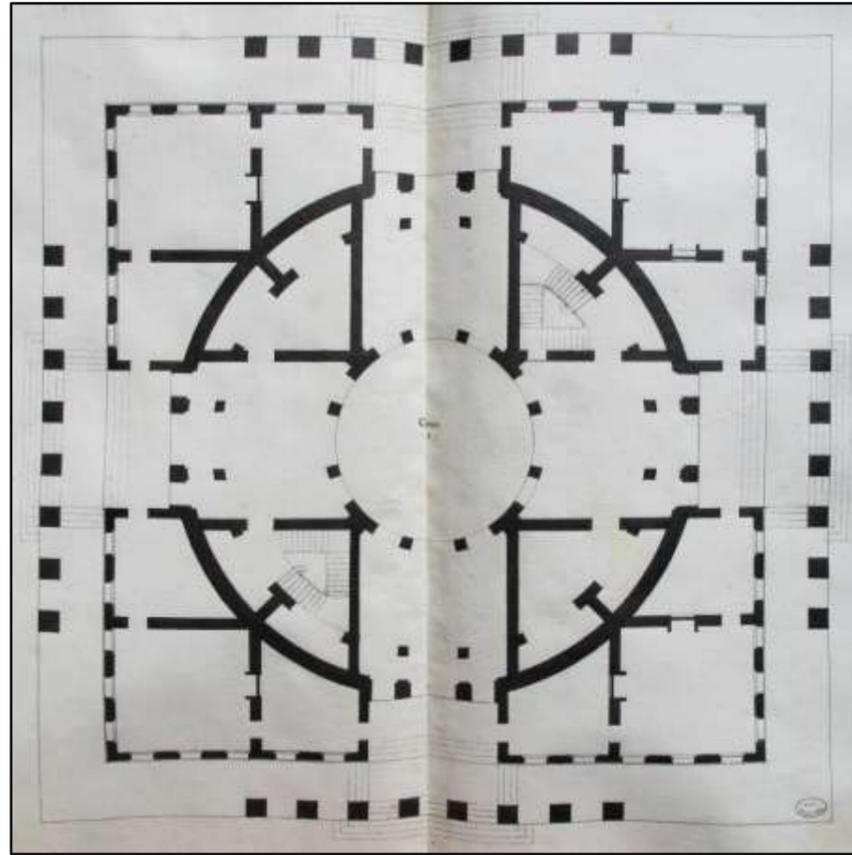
Plan du rez-de-chaussée de la rotonde.
